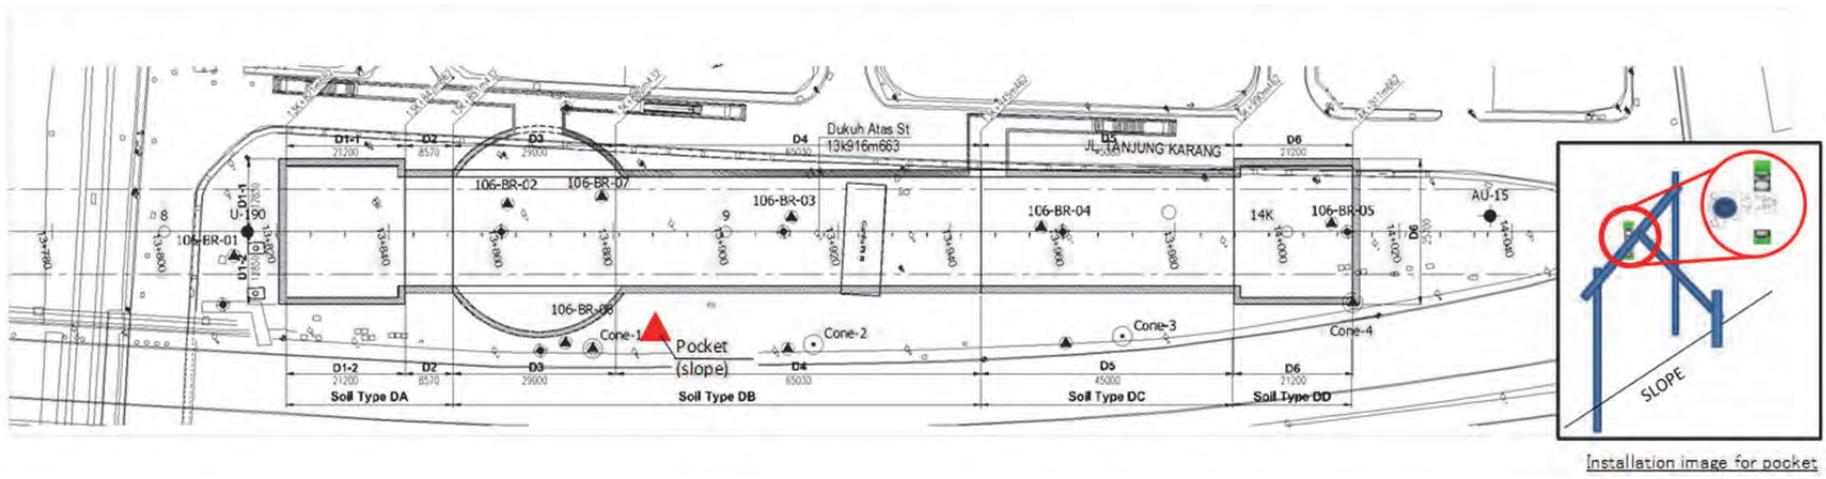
機器配置平面図 (CP106 : DUKUH ATAS station)
